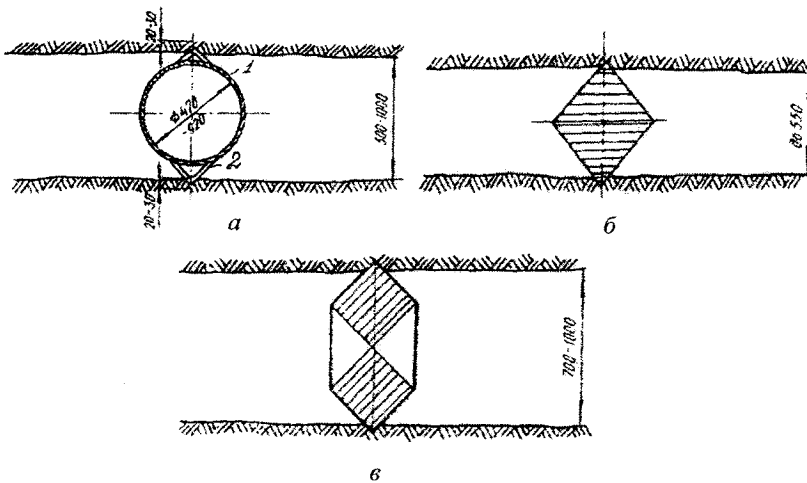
Обмежувачі захваток: *а* – знімний (інвентарний) обмежувач; *б, в* – незнімні стаціонарні обмежувачі з паль; *1* – хомут з арматурної або смугової сталі; *2* – палі
